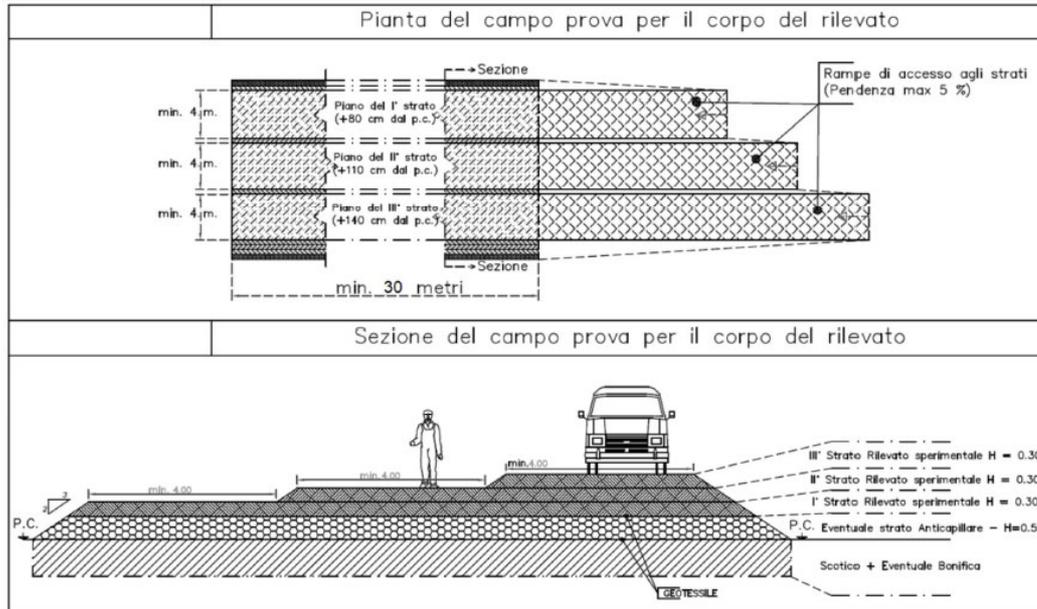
Pianta e sezione del campo prova per il corpo del rilevato
